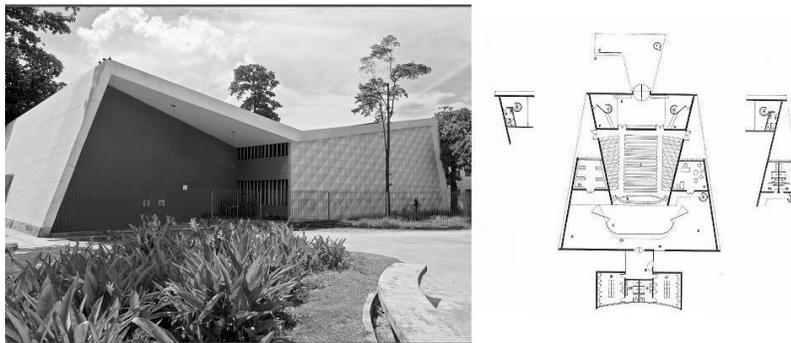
Teatro Armando Gonzaga – Fachada e Planta
